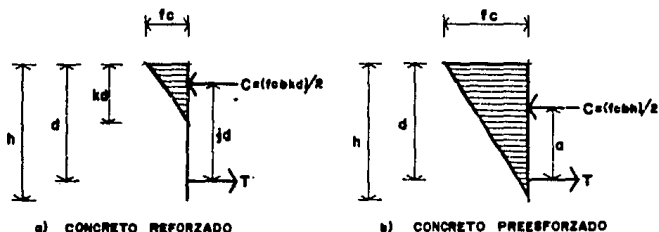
PRISMAS DE ESFUERZOS EN UNA SECCION BAJO CARGAS DE TRABAJO.
